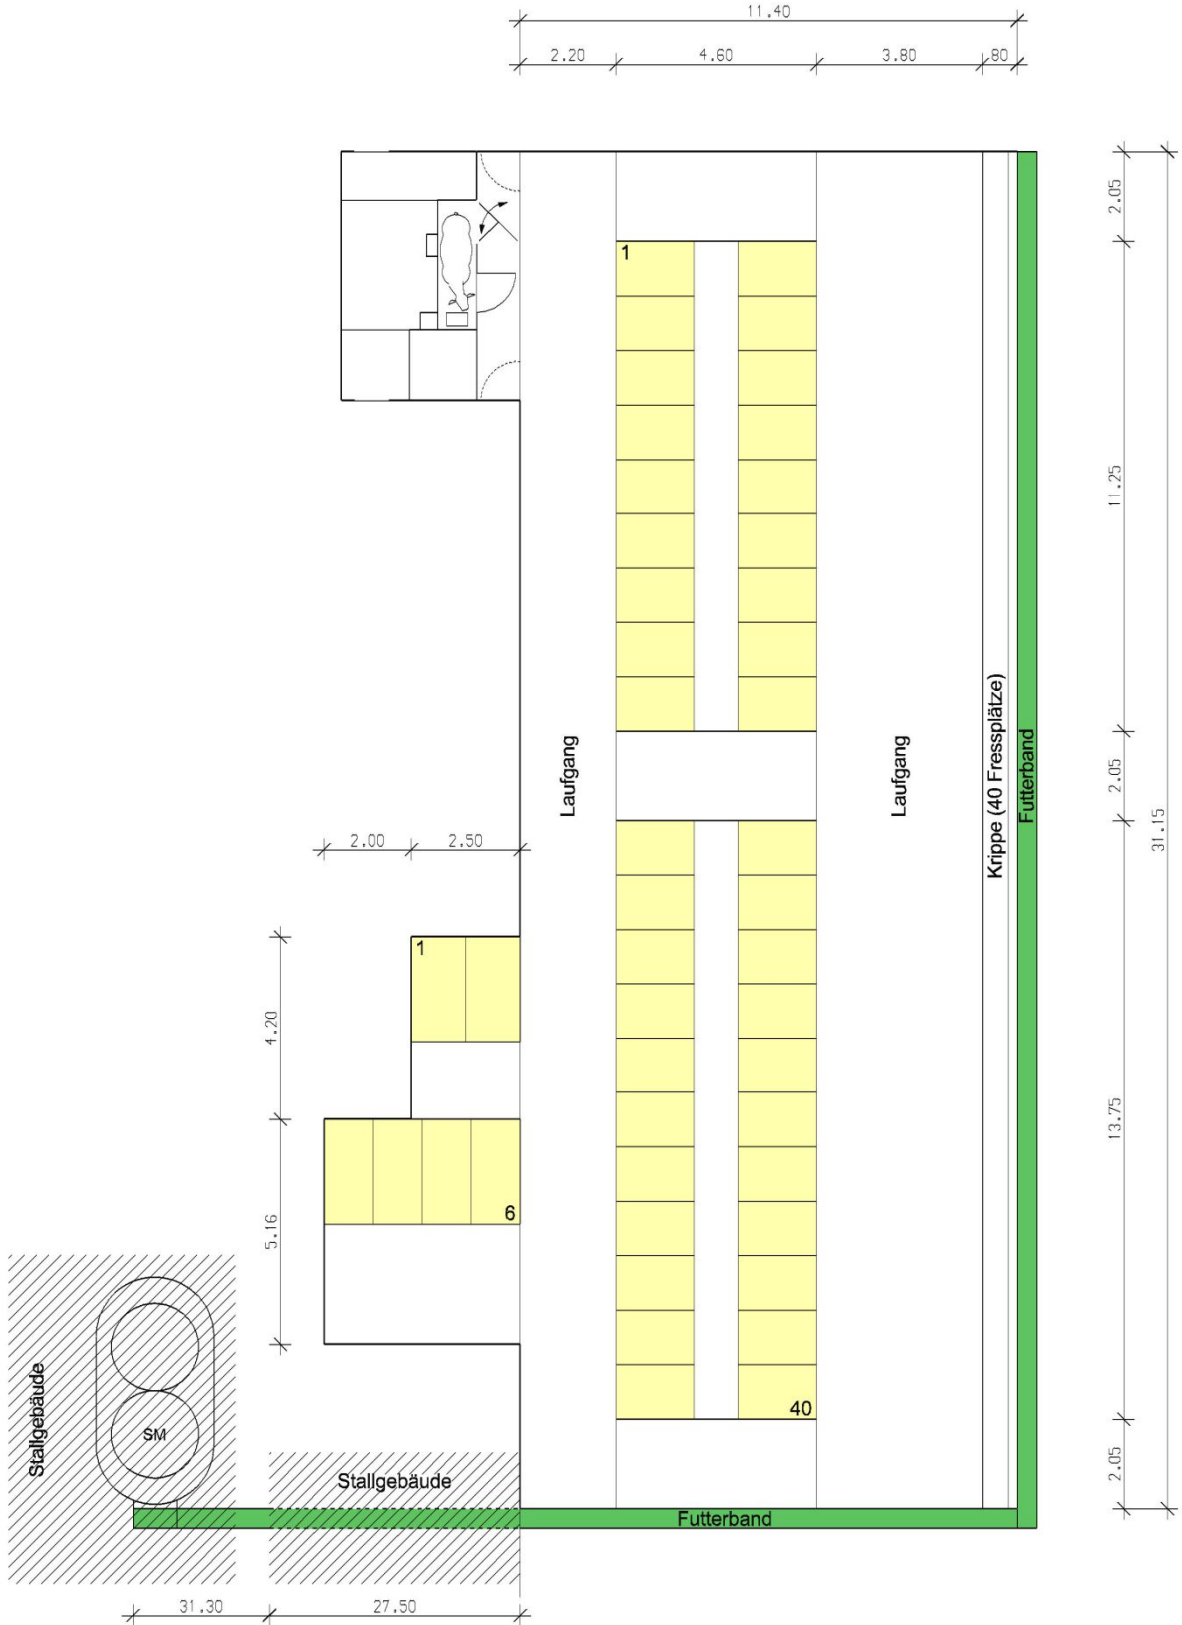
Stallgrundriss Betrieb 2 (SM: stationärer Mischer)
